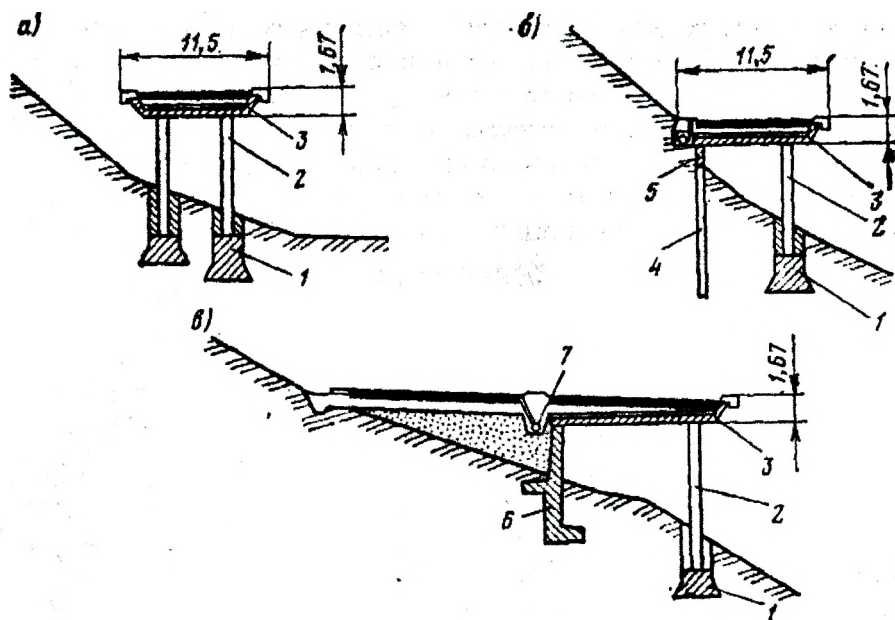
Схемы эстакад и полумостов: а – эстакада вместо высокой насыпи на косогоре; б – полумост; в – сочетание полумоста с насыпью; 1 – фундамент; 2 – стойка; 3 – несущая конструкция; 4 – буровая свая; 5 – продольный ригель; 6 – подпорная стенка; 7 – водосток
